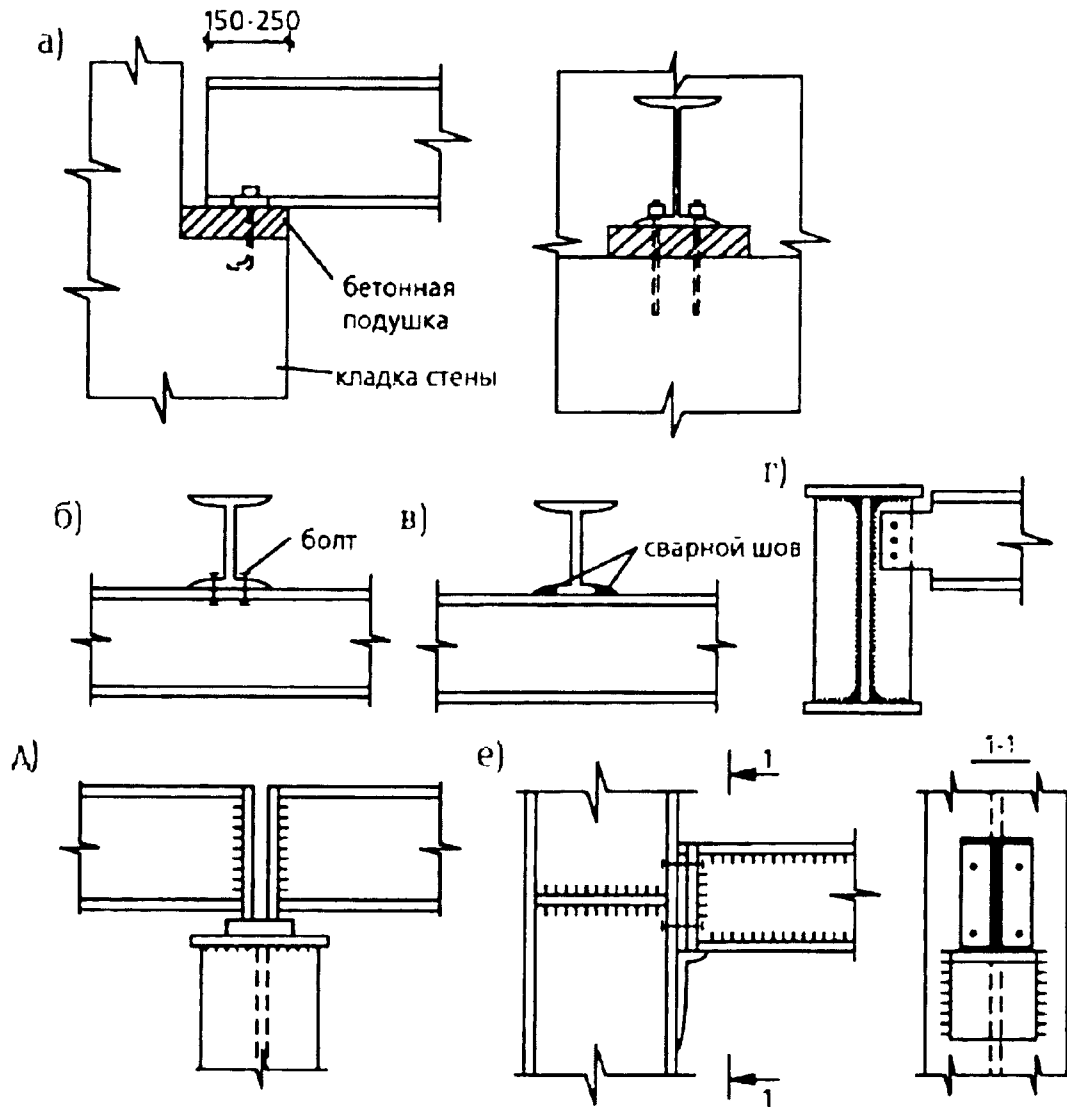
Шарнирное опирание балок: а - на стену; б-г - главные балки; д, е - на колонну
